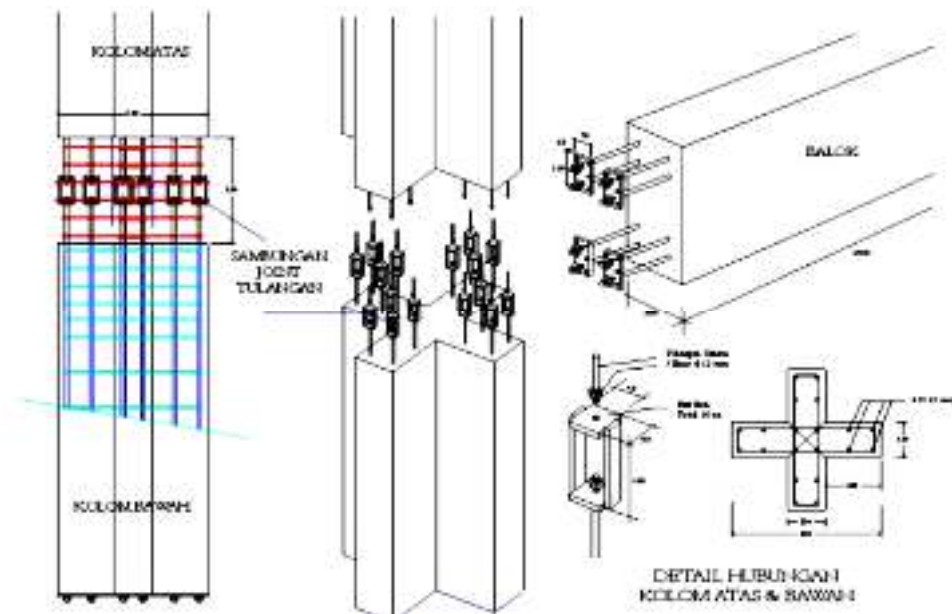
Komponen *precast* dalam struktur bangunan gedung
